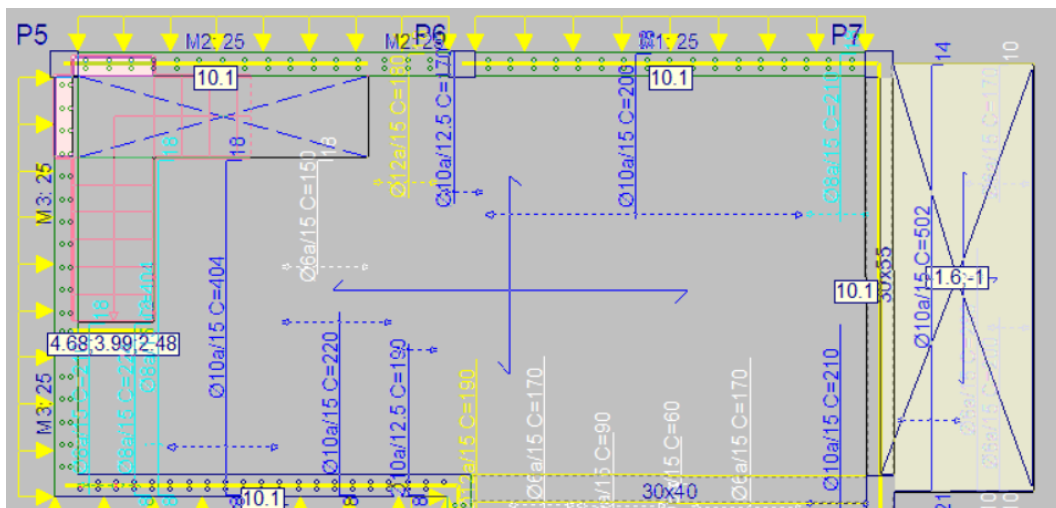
Solução do CYPE para armaduras superiores paralelas ao menor lado da laje
